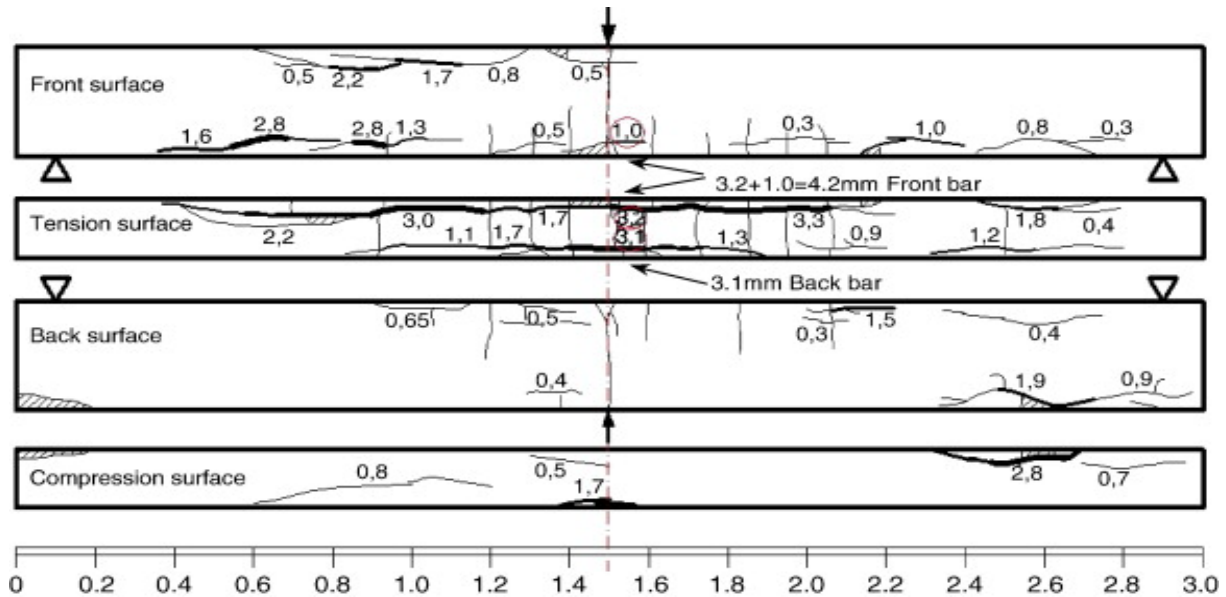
Carte de fissuration de la poutre B2CL1 avec les ouvertures des fissures de corrosion en mm après 23 ans (R. Zhang et al. 2009).
